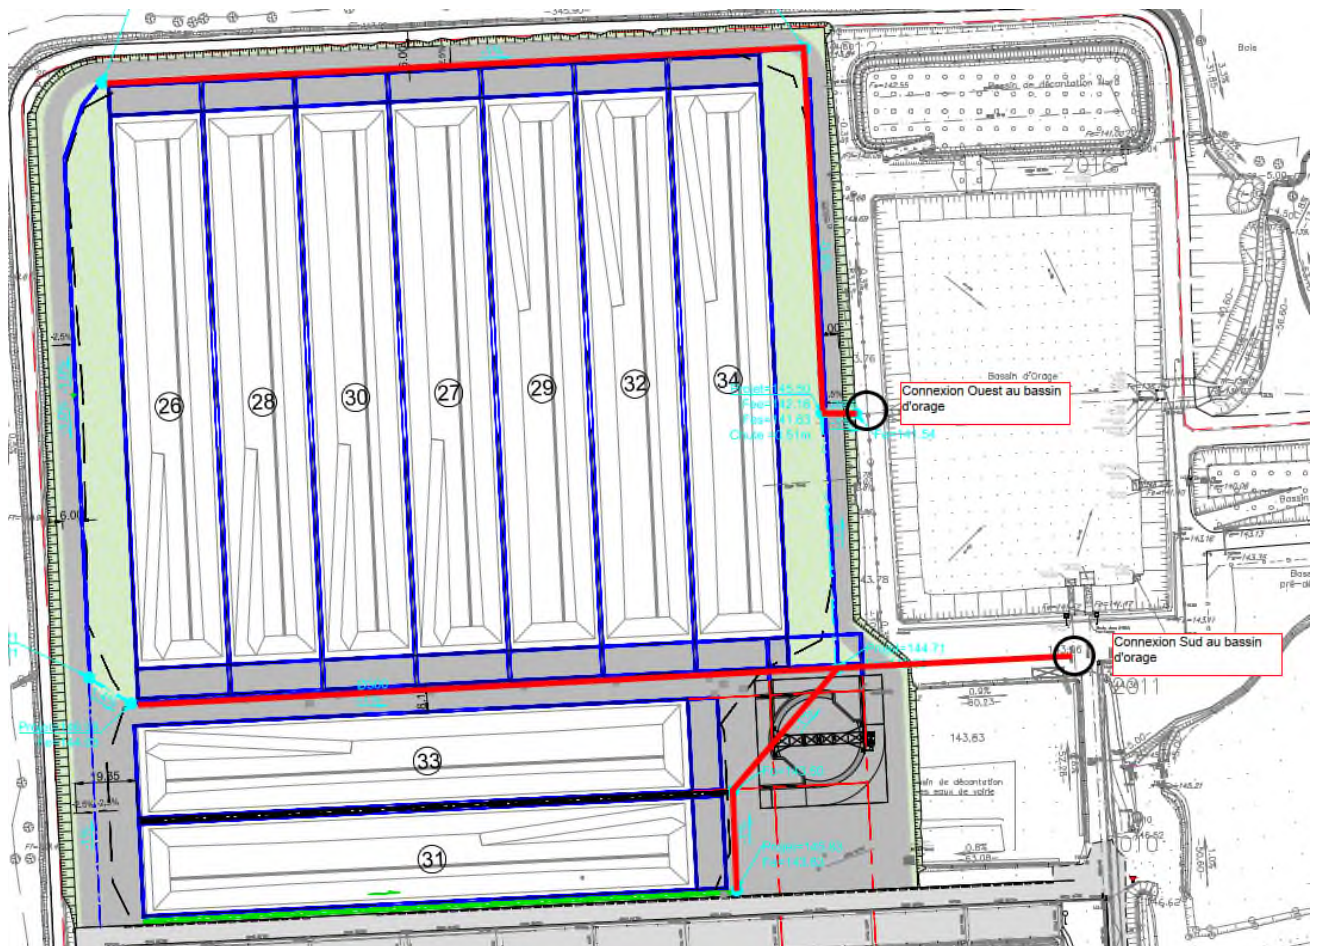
Plan de localisation des collecteurs enterrés de la tranche 3
